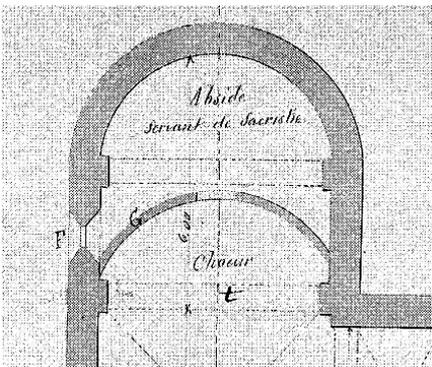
plan du chœur et la travée T5 relevé par l'architecte Favrot en 1879
